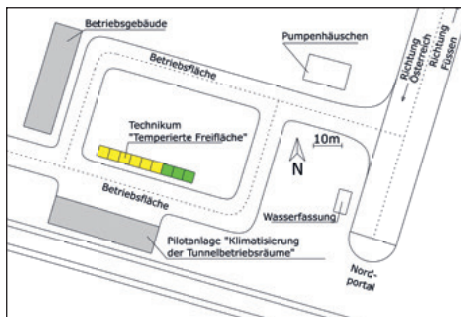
TECHNIKUM Füssen: gelb markierte Flächen mit Fahrbahnaufbau aus Asphalt, grün markierte Flächen mit Aufbau aus Beton.
